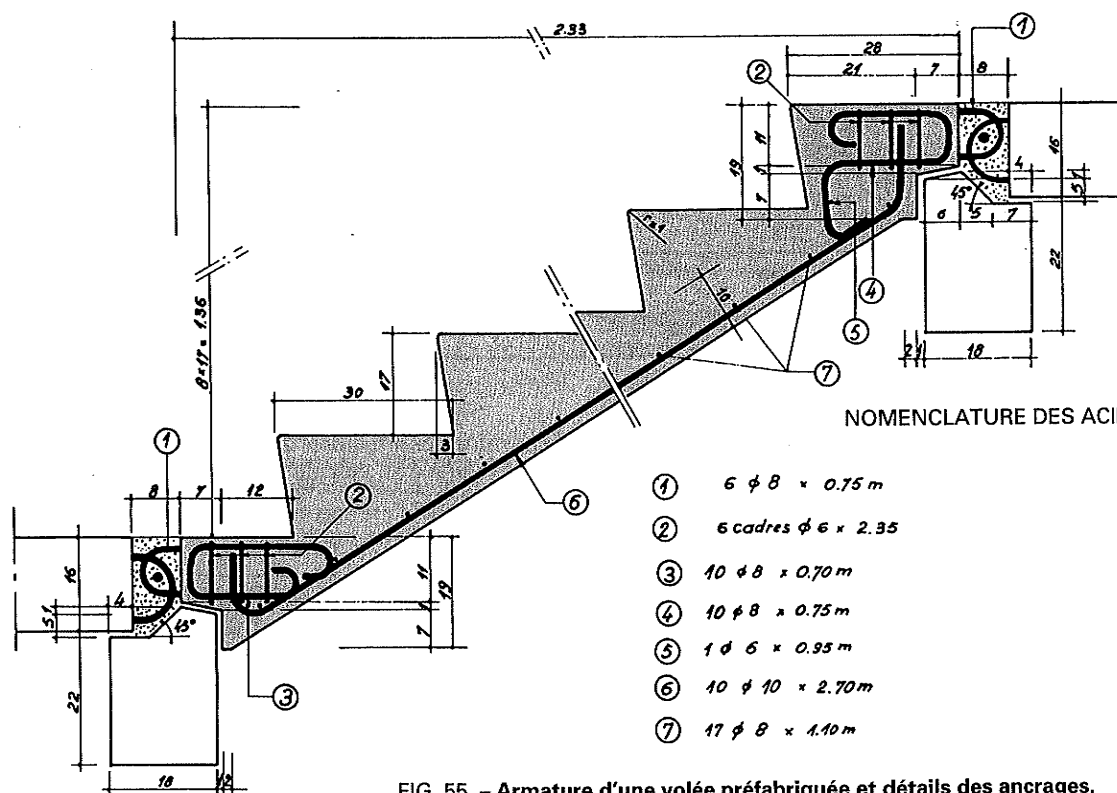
Armature d'une volée préfabriquée et détails des ancrages.
